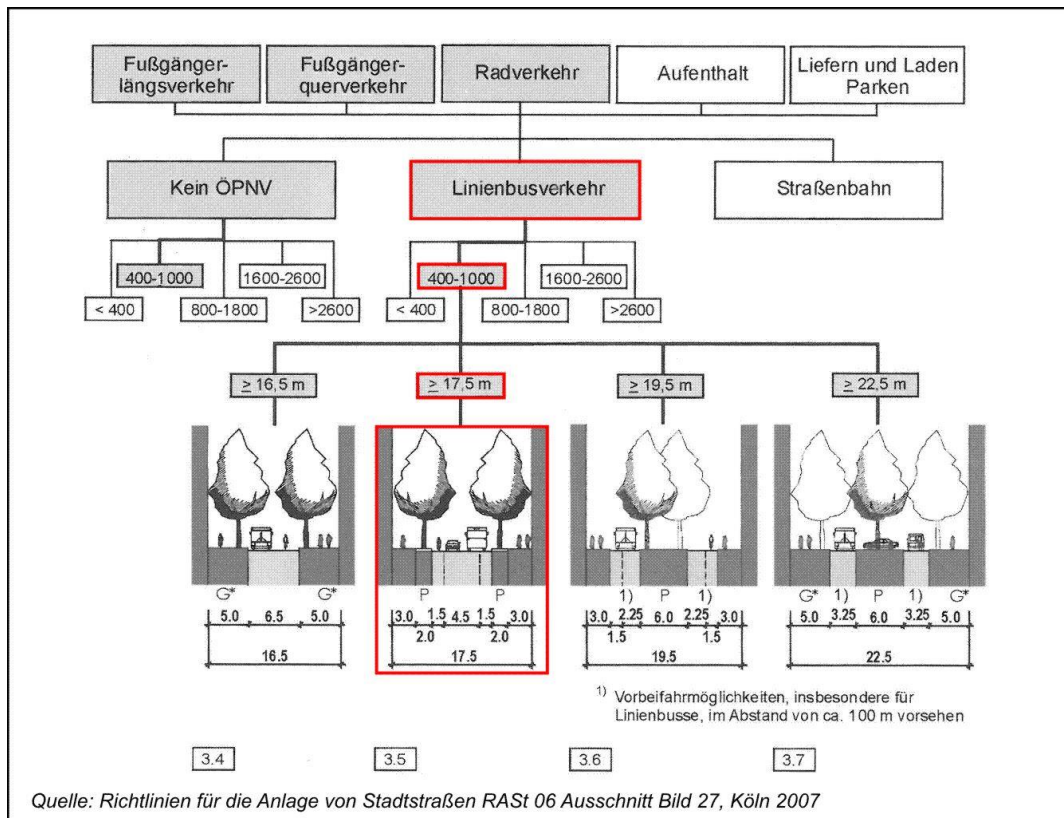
Anlage des Straßenraumprofils nach RAST 06
